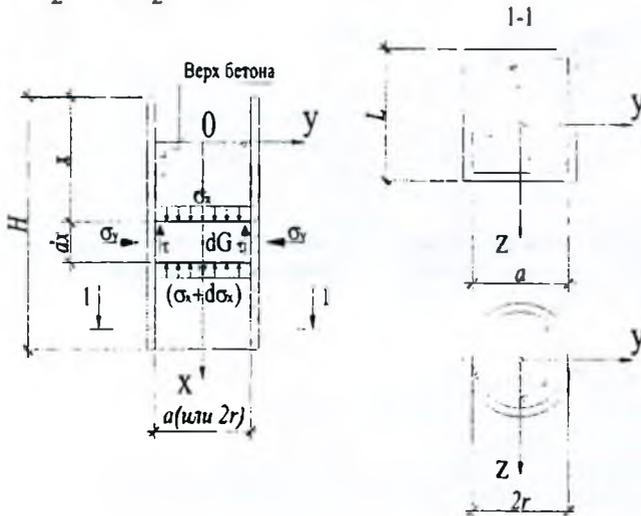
Расчетная схема для определения давления бетонной смеси на вертикальную прямоугольную и круглую опалубку
